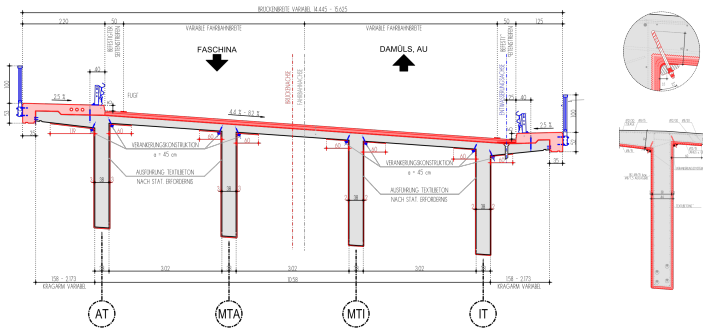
Verstärkung der Stege der Brücke mittels Textilbeton und Verankerung mit Betonschrauben in der Fahrbahnplatte, Planauszug Prof. Feix Ingenieure GmbH
